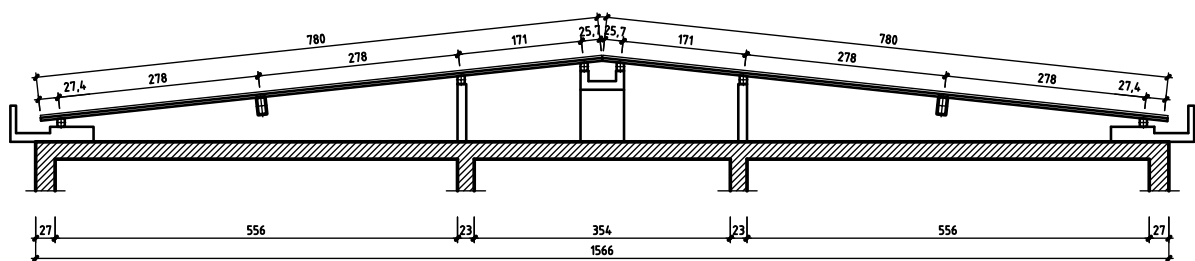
Sezione trasversale della copertura nello stato di progetto.
